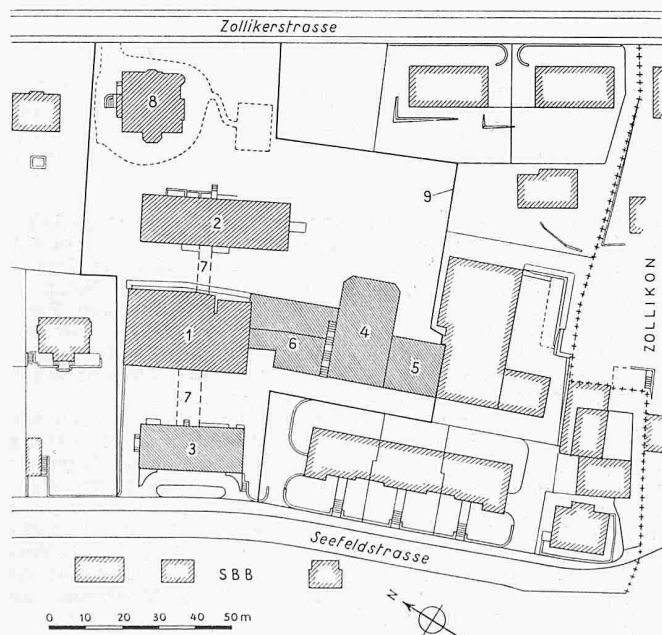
Lageplan 1:2000 der SEV-Liegenschaft
